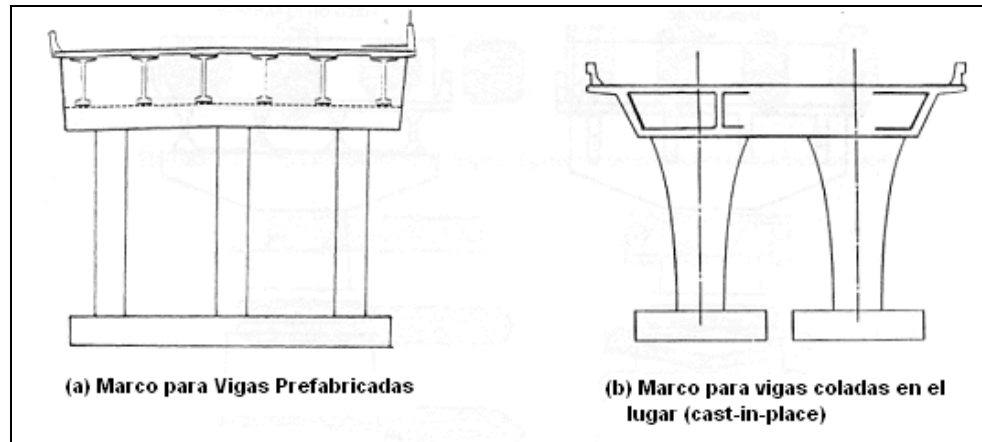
Tipos de pilas típicas para puentes de concreto.
